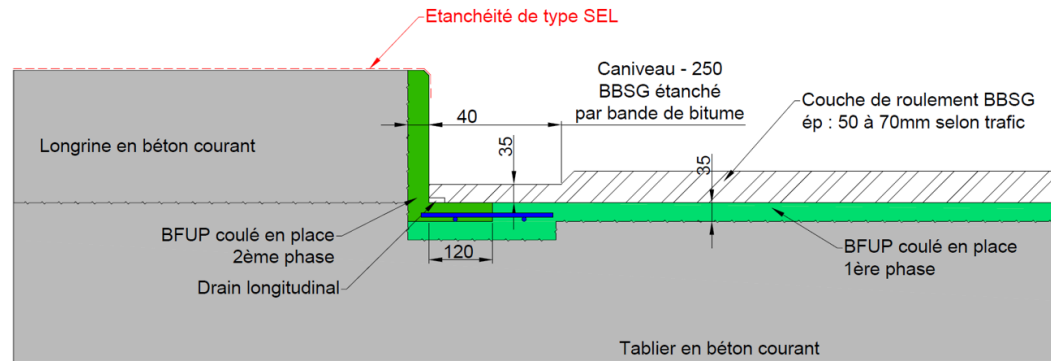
Exemple de bonne disposition dans le cas où une étanchéité par BFUP est prévue sous chaussée mais pas sur les longrines
